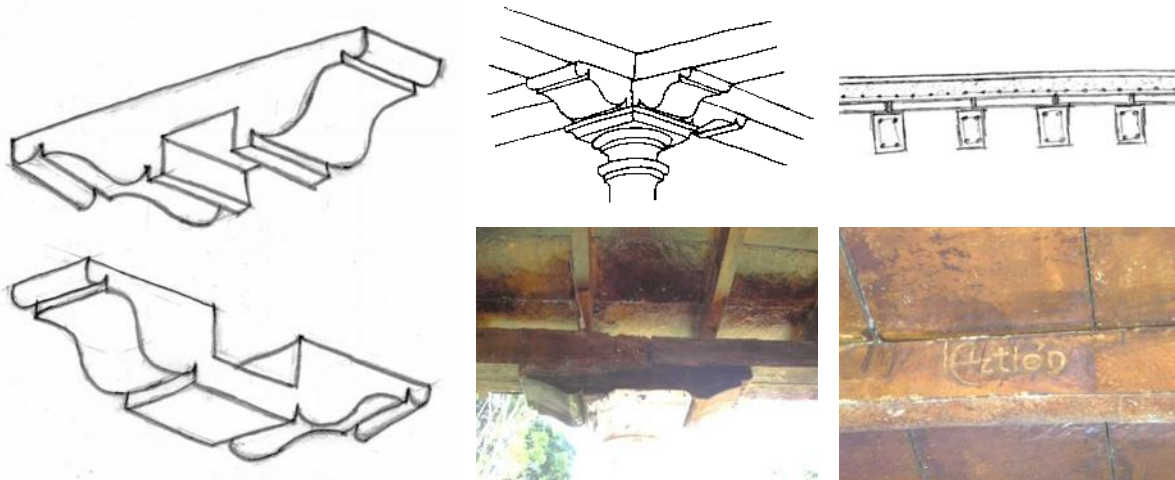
Croquis y fotos del sistema constructivo de apoyos con los ensambles de capiteles en las esquinas de los corredores, así como la cubierta a base de elementos prefabricados de concreto, en los corredores sur y poniente.
